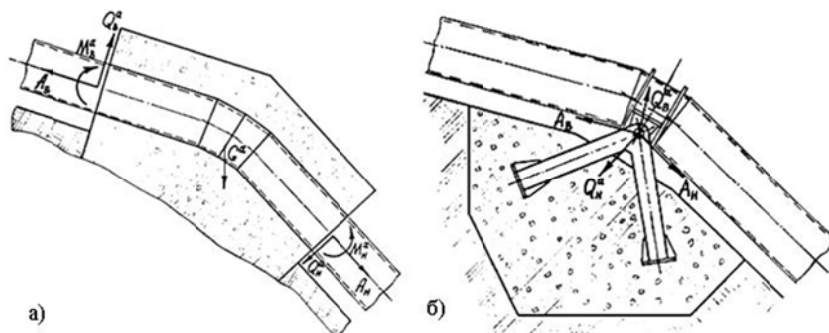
Анкерная опора: а) схема сил, действующих на обетонированную анкерную опору; б) схема сил, действующих на шарнир открытой анкерной опоры
